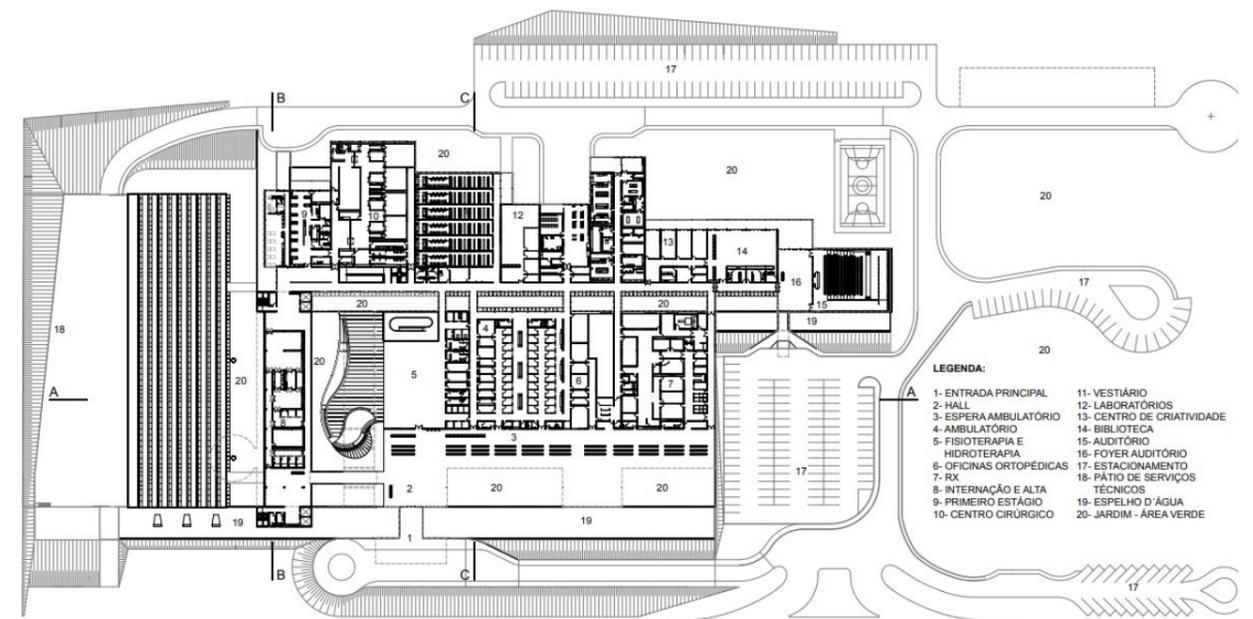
Planta baixa do térreo Fonte: Jorge Isaac Monteiro 2017
